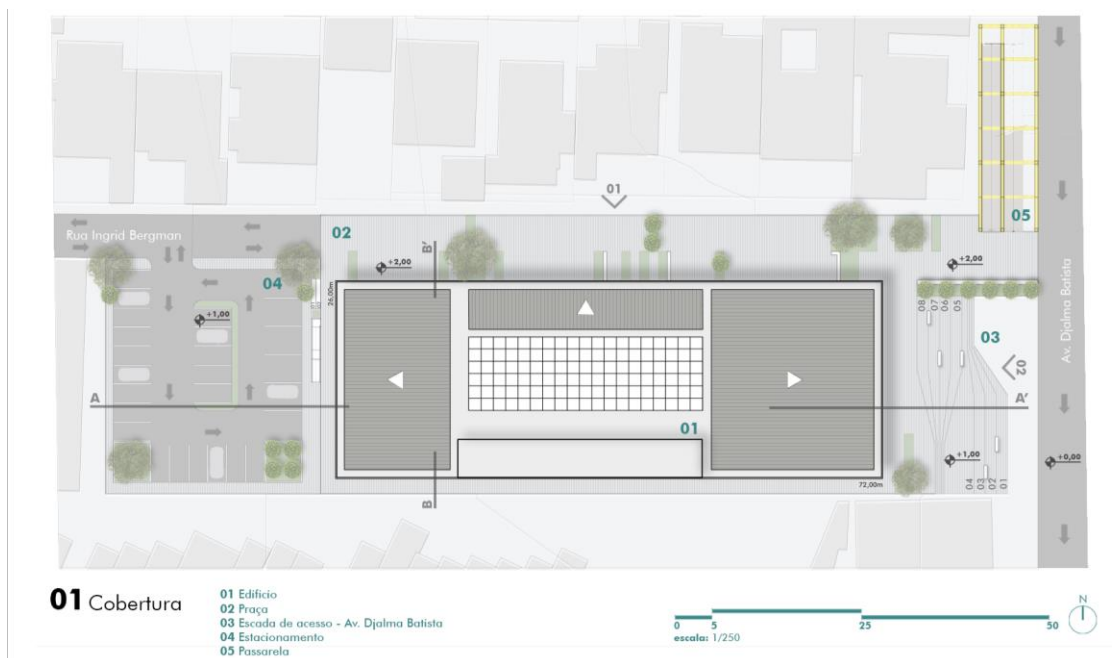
Planta de Cobertura. Fonte: acervo da autora, 2021
